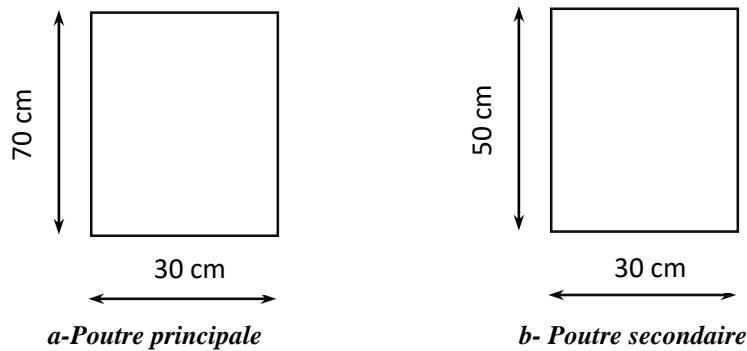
Pré-dimensionnement de la poutre (partie centrale)
